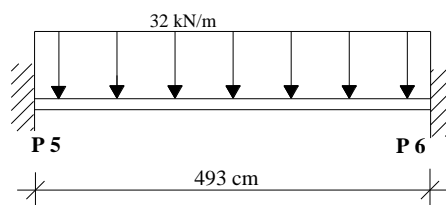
Esquema estático e carregamento no vão da viga adjacente ao pilar P6.
